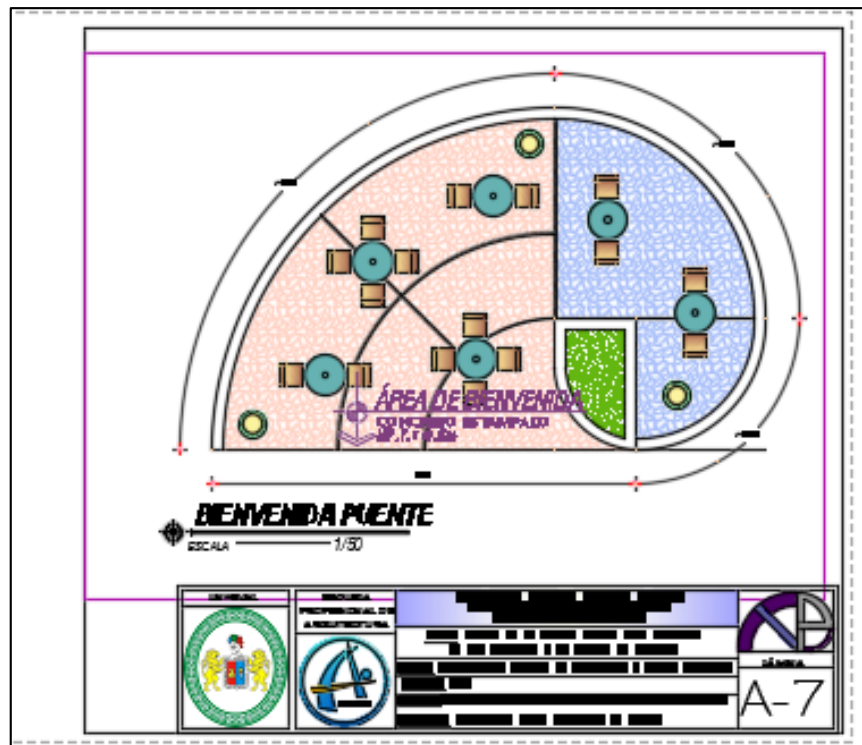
Plano de espacio de bienvenida para puente Calicanto.
